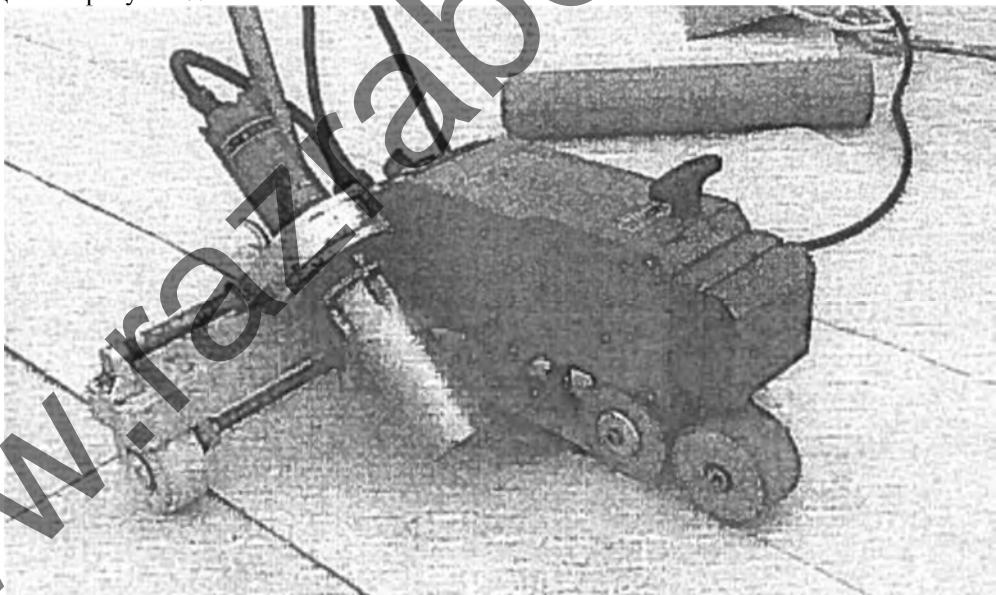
Схема сварки и уплотнения швов ПВХ-мембранны с помощью автоматического сварочного аппарата
